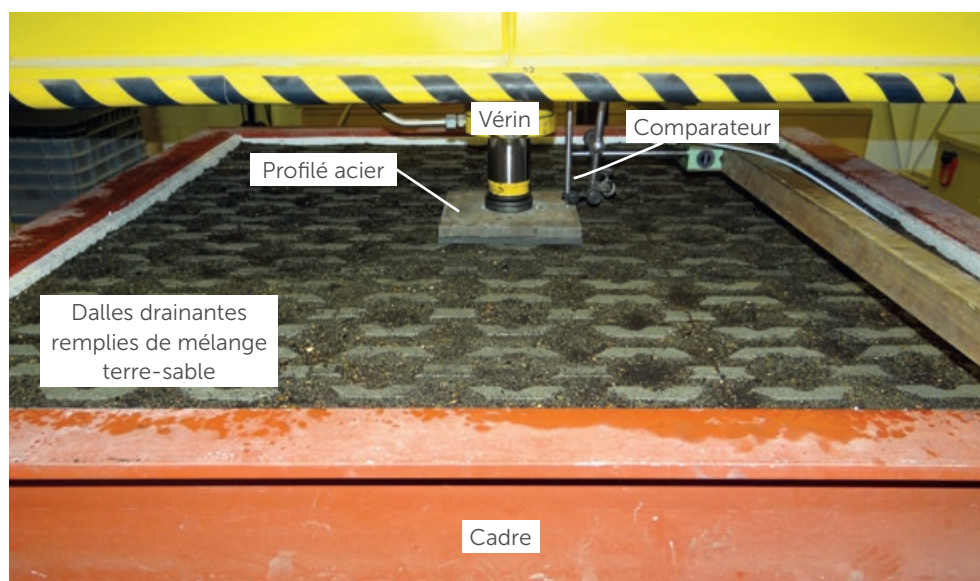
Principe de l'essai en conditions de pose sur dalles drainantes.
